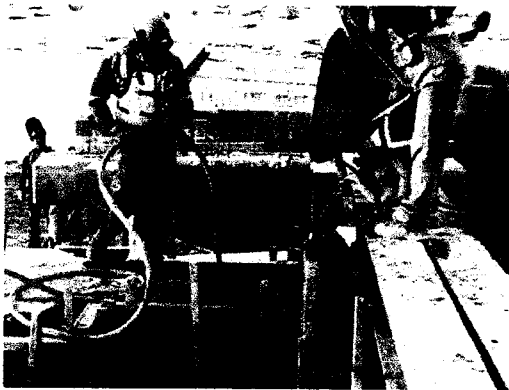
y 50: Armadura de acero de refuerzo en juntas puente de acceso. Muelle
